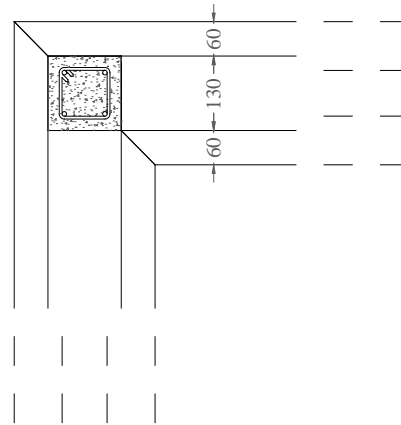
Détail des coins, 3, en plan avec le ferrailage vertical
